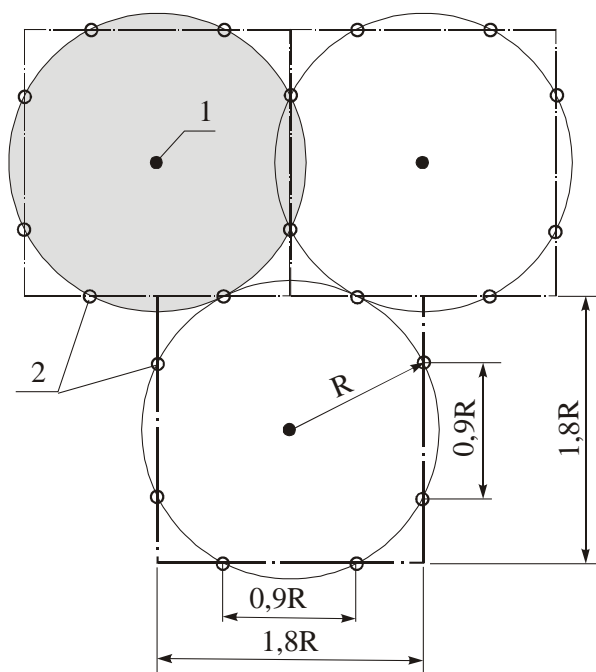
Рекомендуемая схема расположения в кровле напорных патрубков (1) и дренажных отверстий (2) для сушки теплоизоляции
